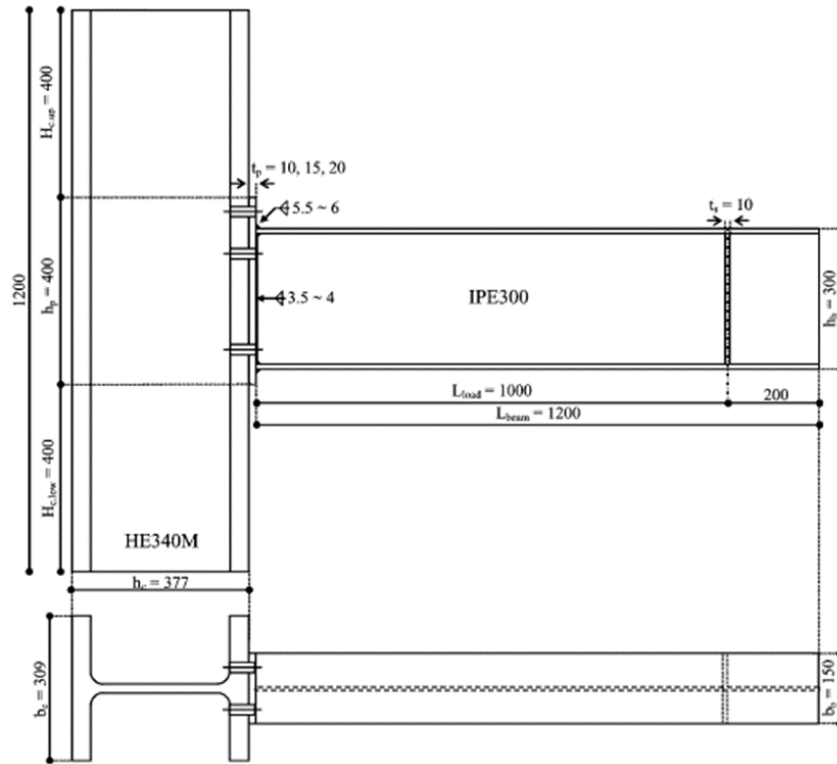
Geometría de los elementos (dimensiones en mm)
